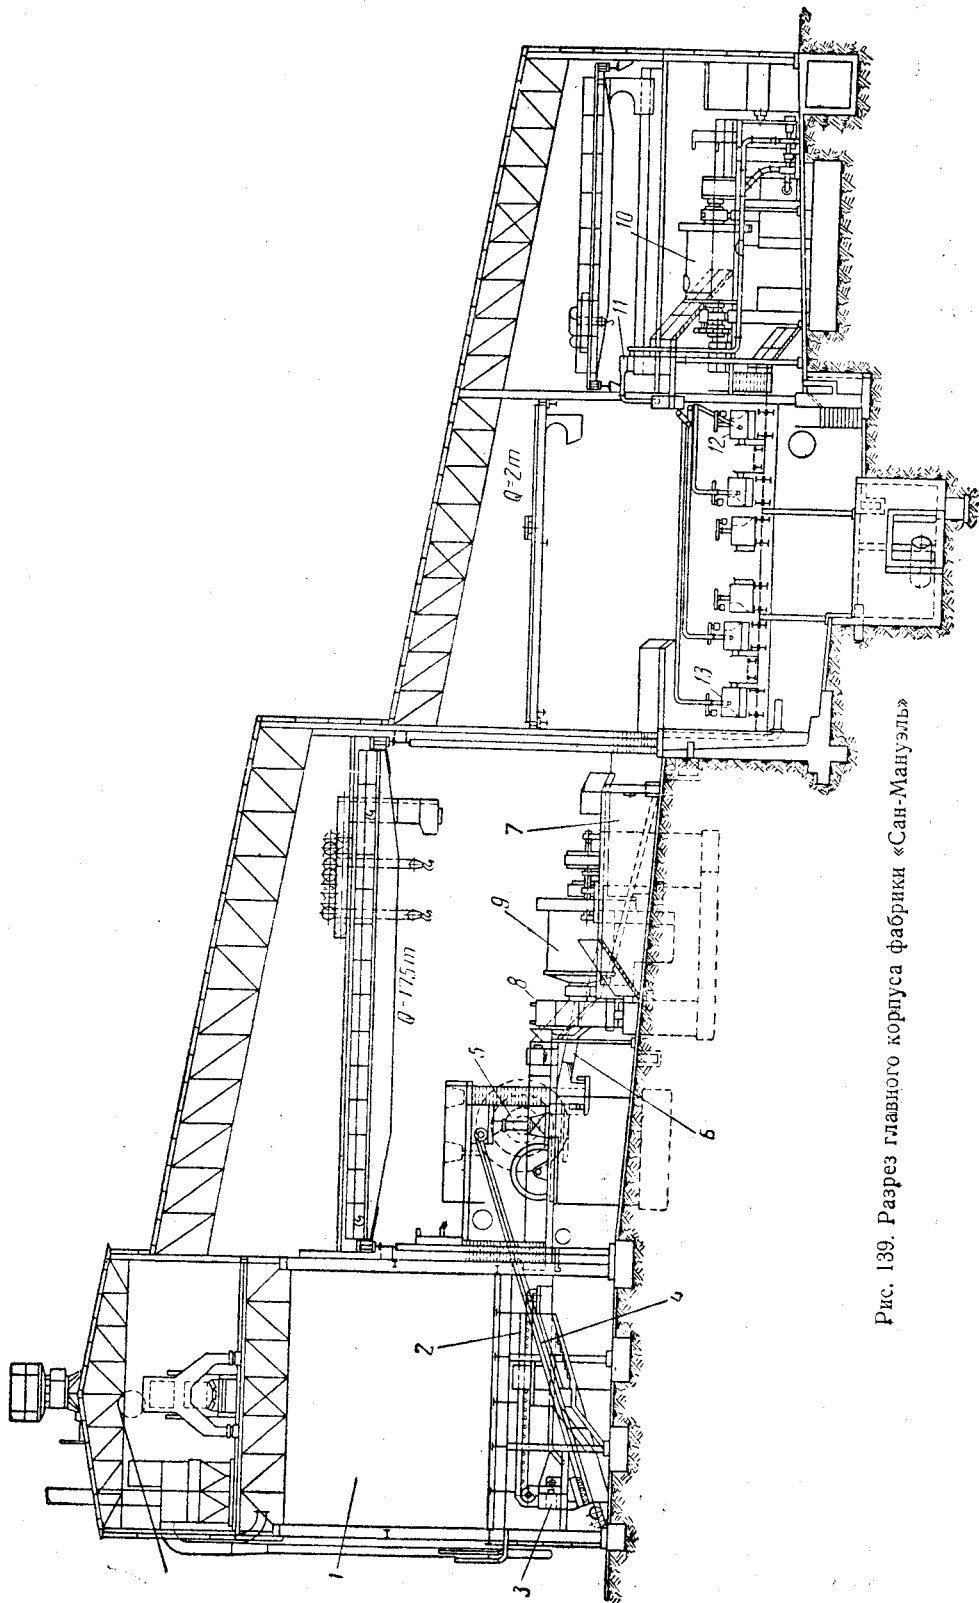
Разрез главного корпуса фабрики «Сан-Мануэль»
